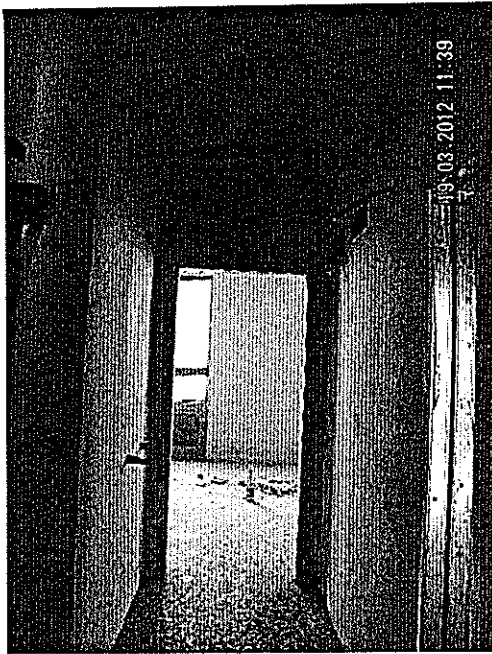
Vano scale: Vista porta ingresso stanza\_1.1
